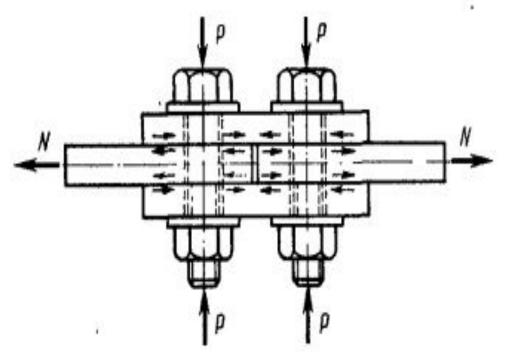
Схема работы соединения на высокопрочных болтах
